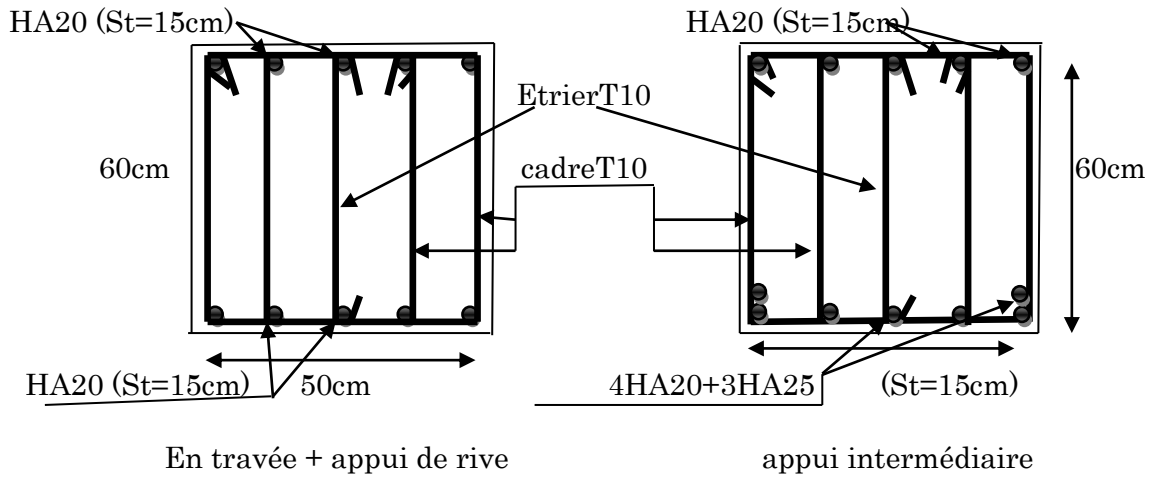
Schéma de ferrailage de la poutre de rigidité
